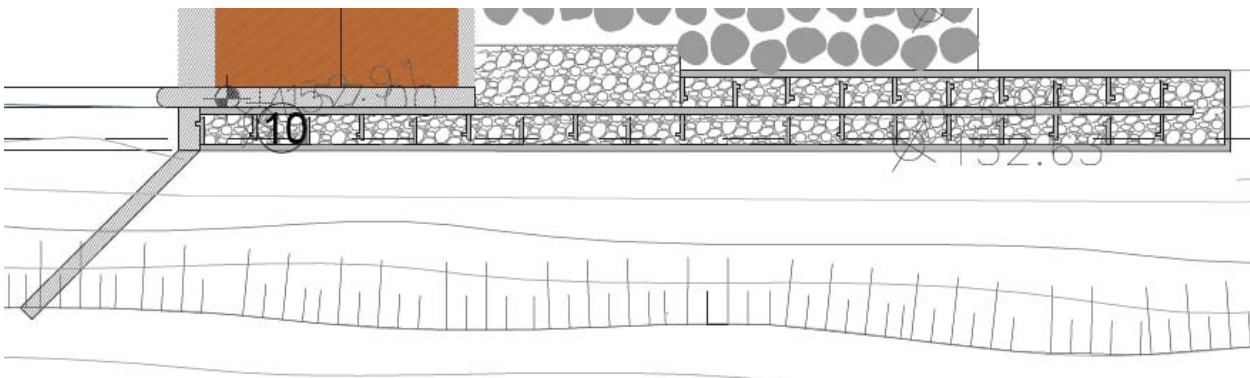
Particolare della pianta del passaggio di rimonta progettato
